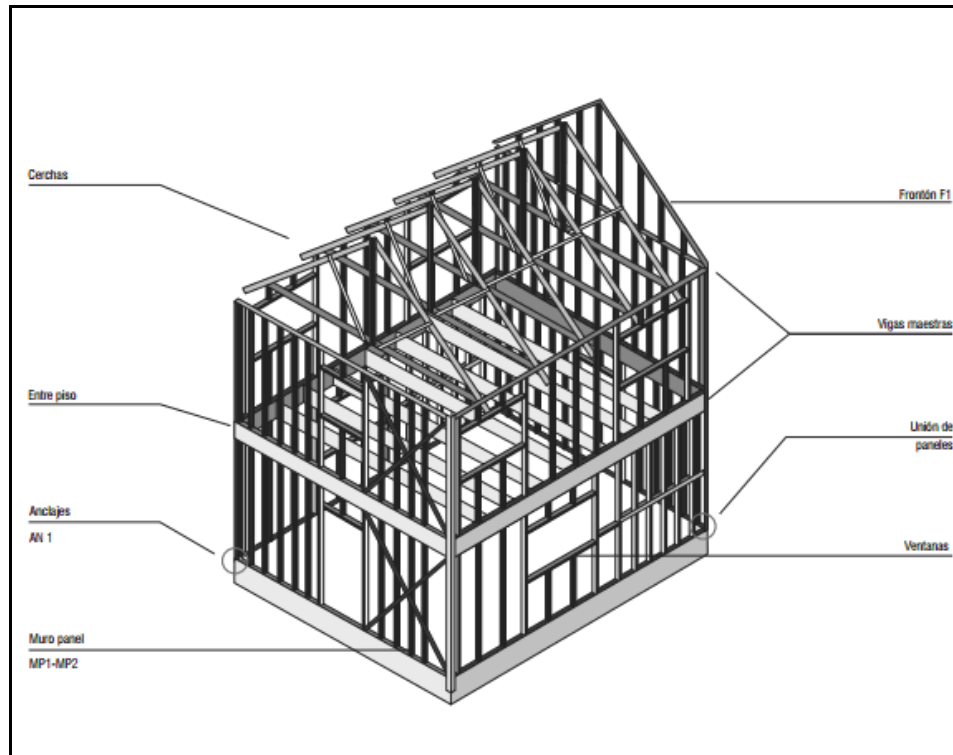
Estructura compuesta por paneles estructurales de Metalcon.-
